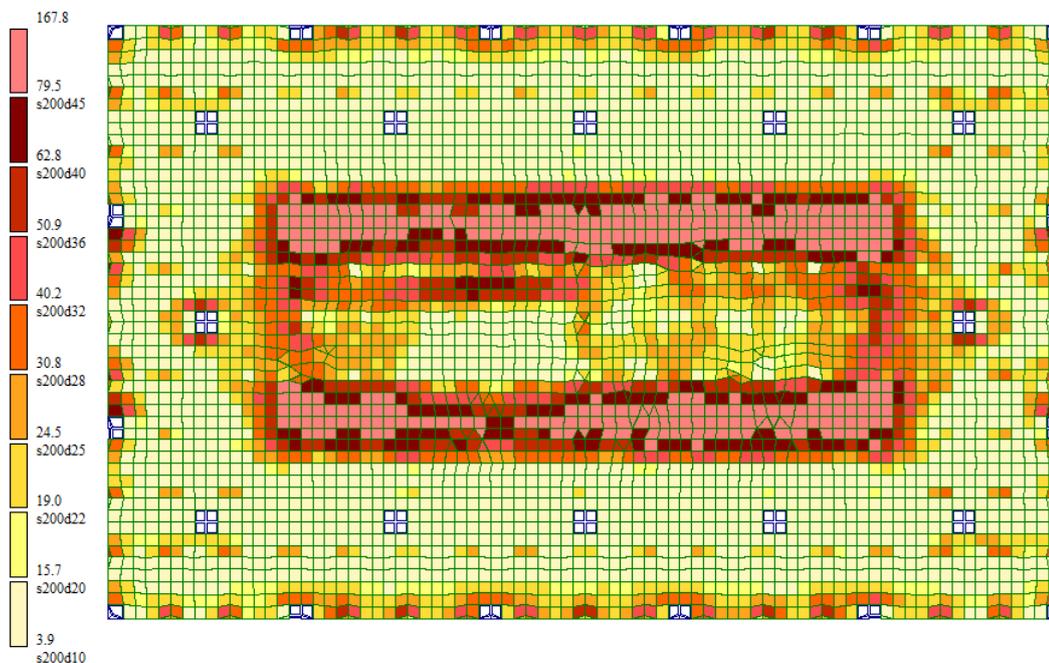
Схема армирования низа фундаментной плиты по оси OY
